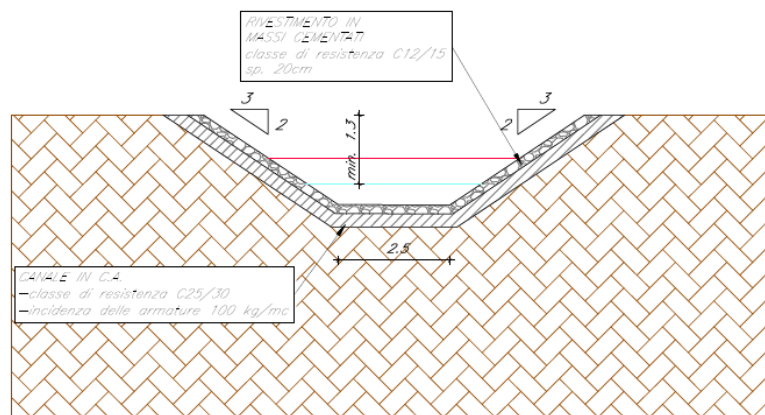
Sezione tipo sistemazione corso d'acqua 13+650.
